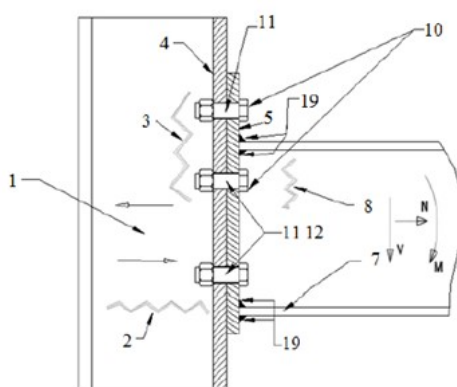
Componentes ativos da ligação viga-pilar – chapa de extremidade (adaptada de Oliveira, C., 2011)
